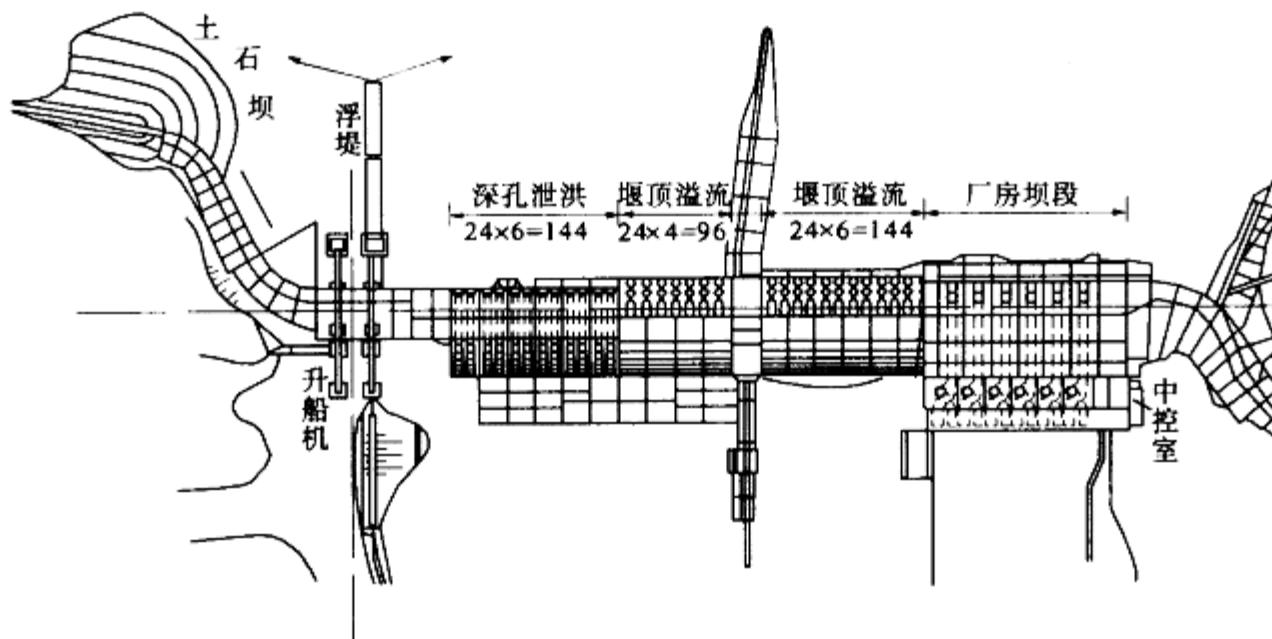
丹江口(坝后式)水电站枢纽平面布置图
